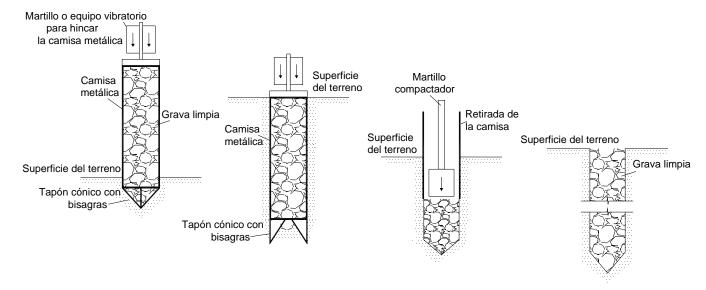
Métodos Constructivos Pilotes de Grava
